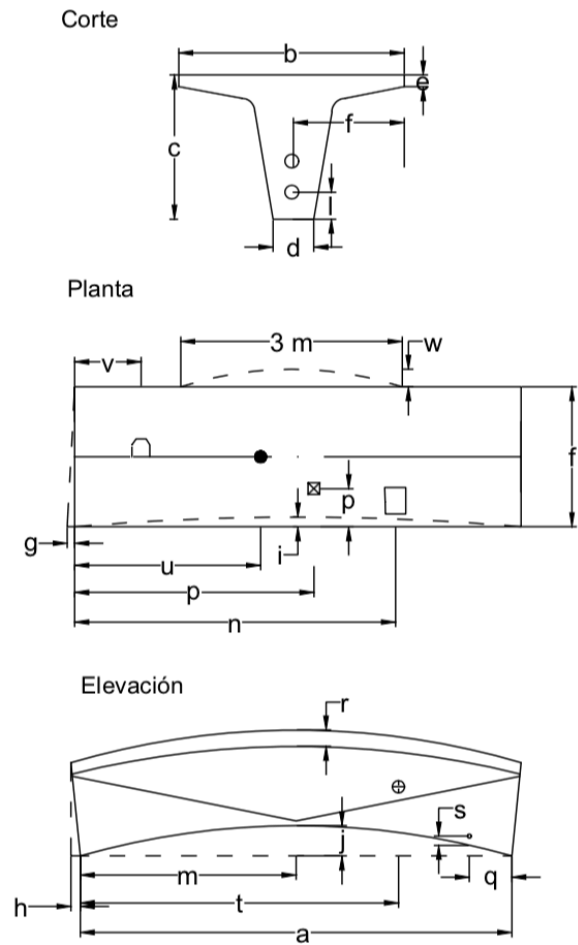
Tolerancias geométricas para Sección T presforzadas.
